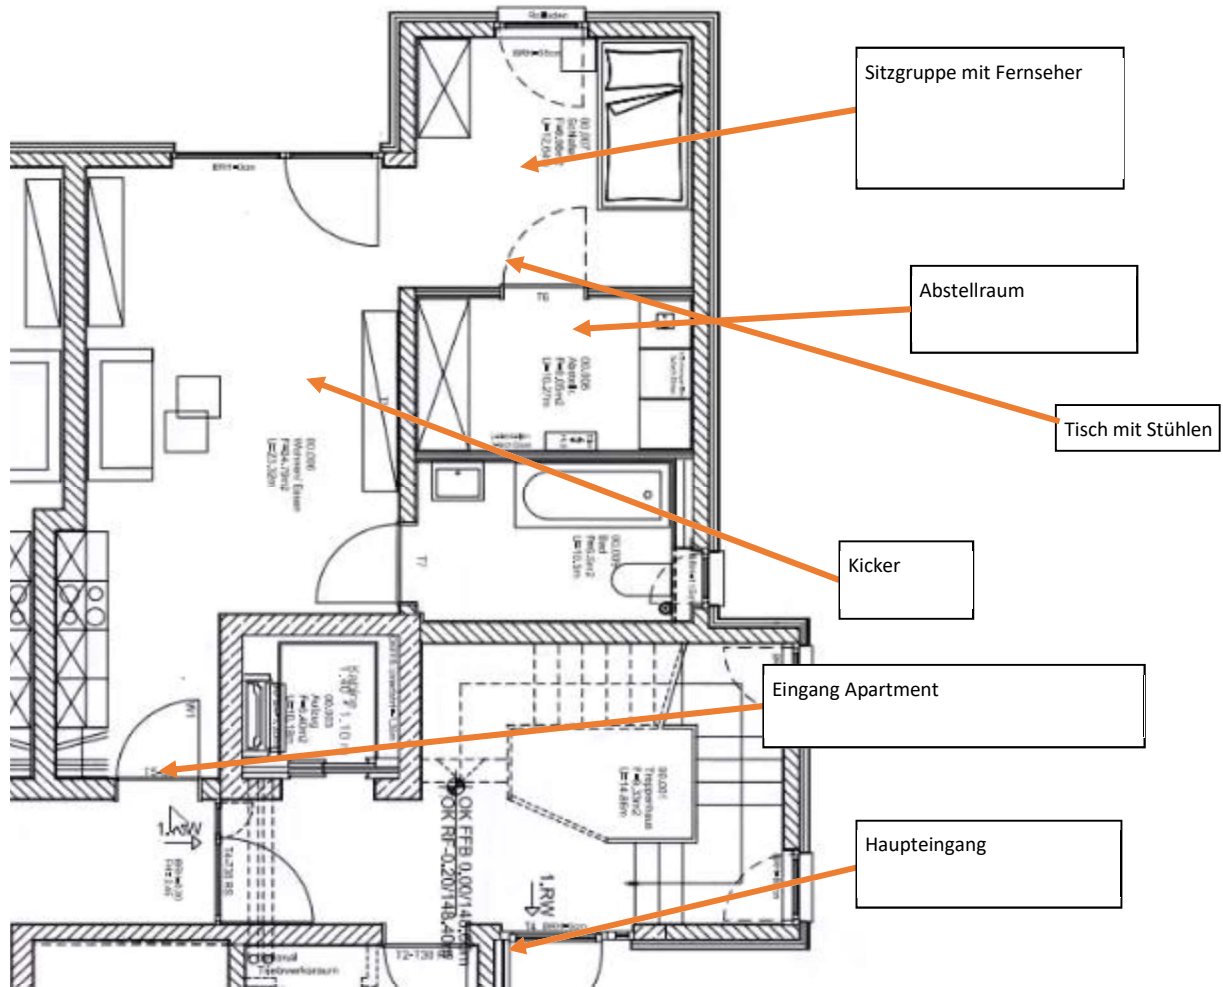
Grundriss Gemeinschaftsraum in Detmold
